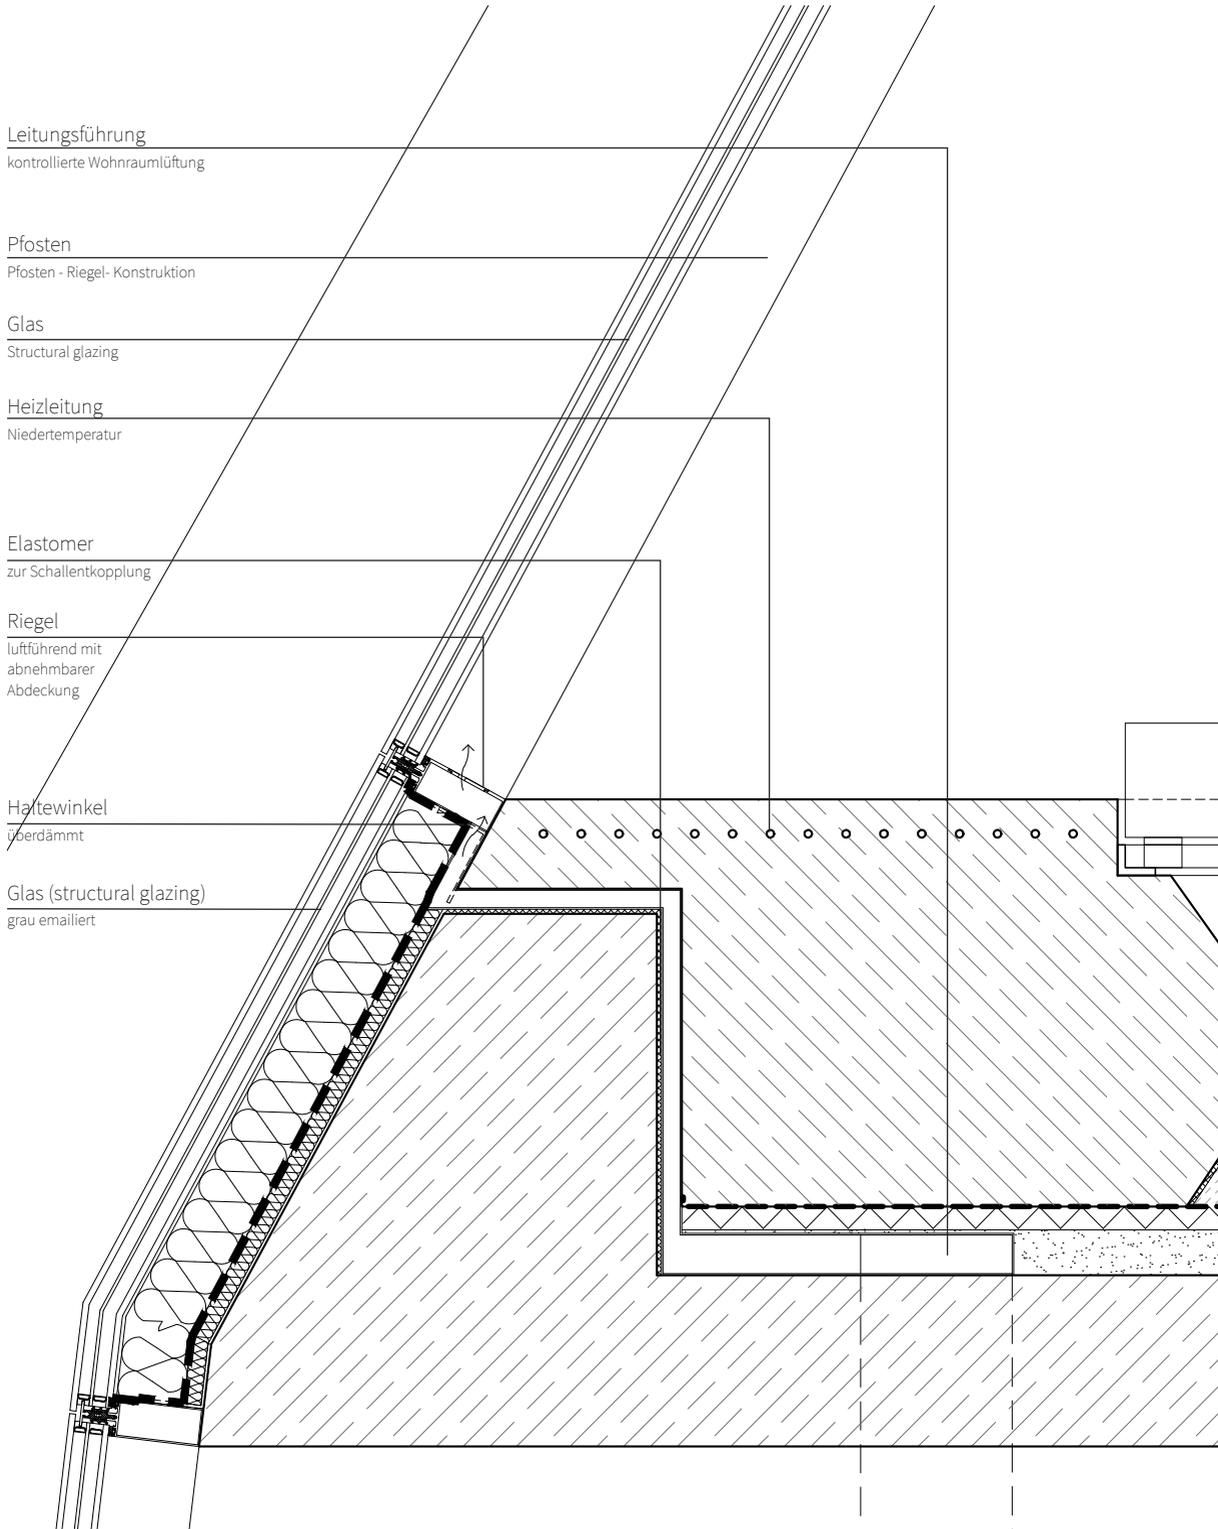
| Möblierung Hotelzimmer Junior - Suite Detailschnitt 2 | Doppelbett aus Möbelbeton
